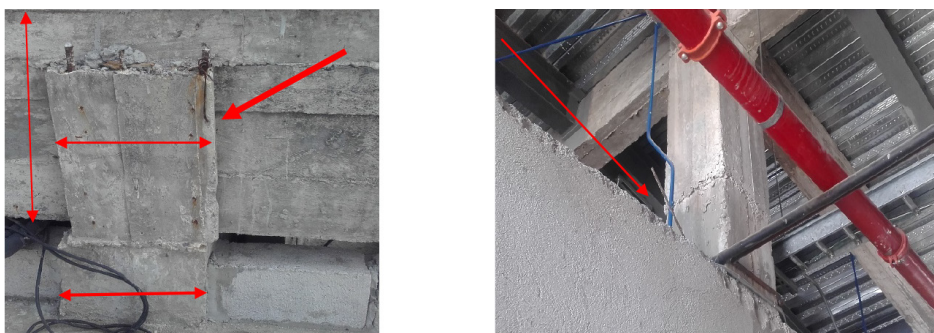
Falla en elementos estructurales, viga fuerte y columna débil, juntas frías.
